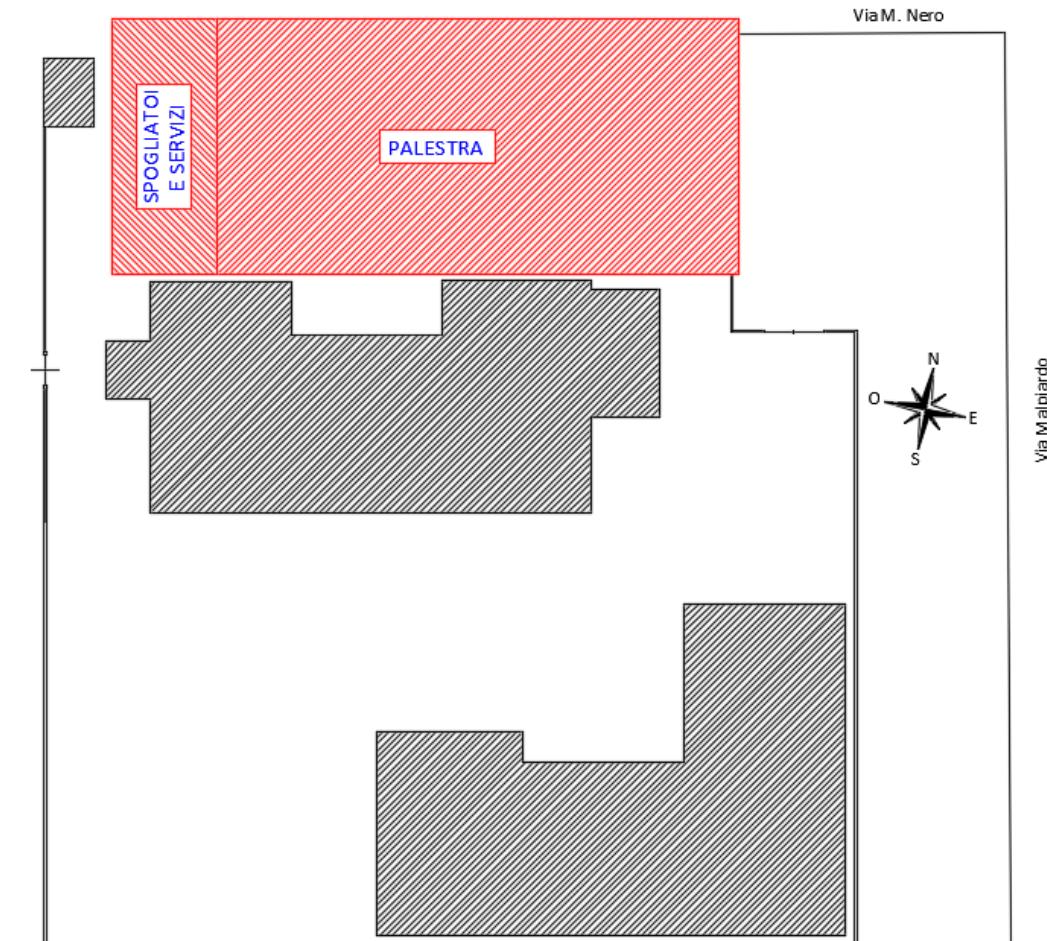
Individuazione specifica delle strutture oggetto di intervento
